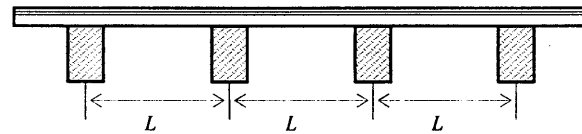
Hubungan rasuk baja tipe I dan balok lantai
